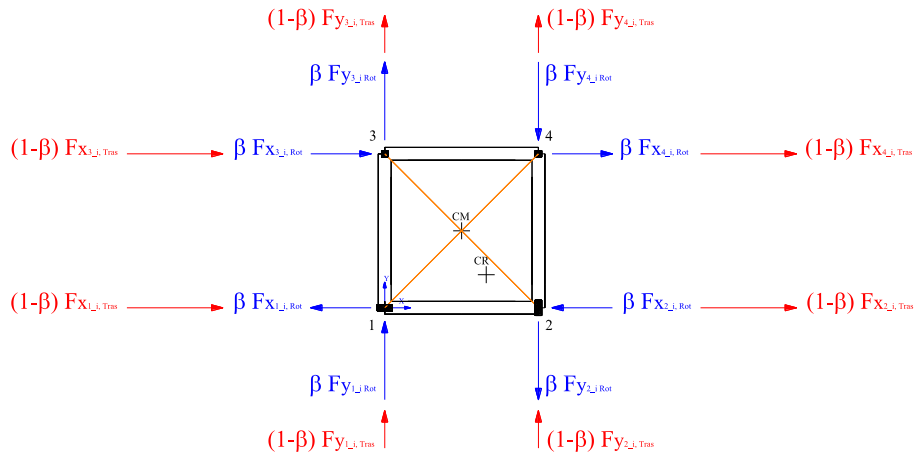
Distribuzione delle azioni in pianta al variare di β , struttura con eccentricità bi-direzionale fra C_R e C_M .
